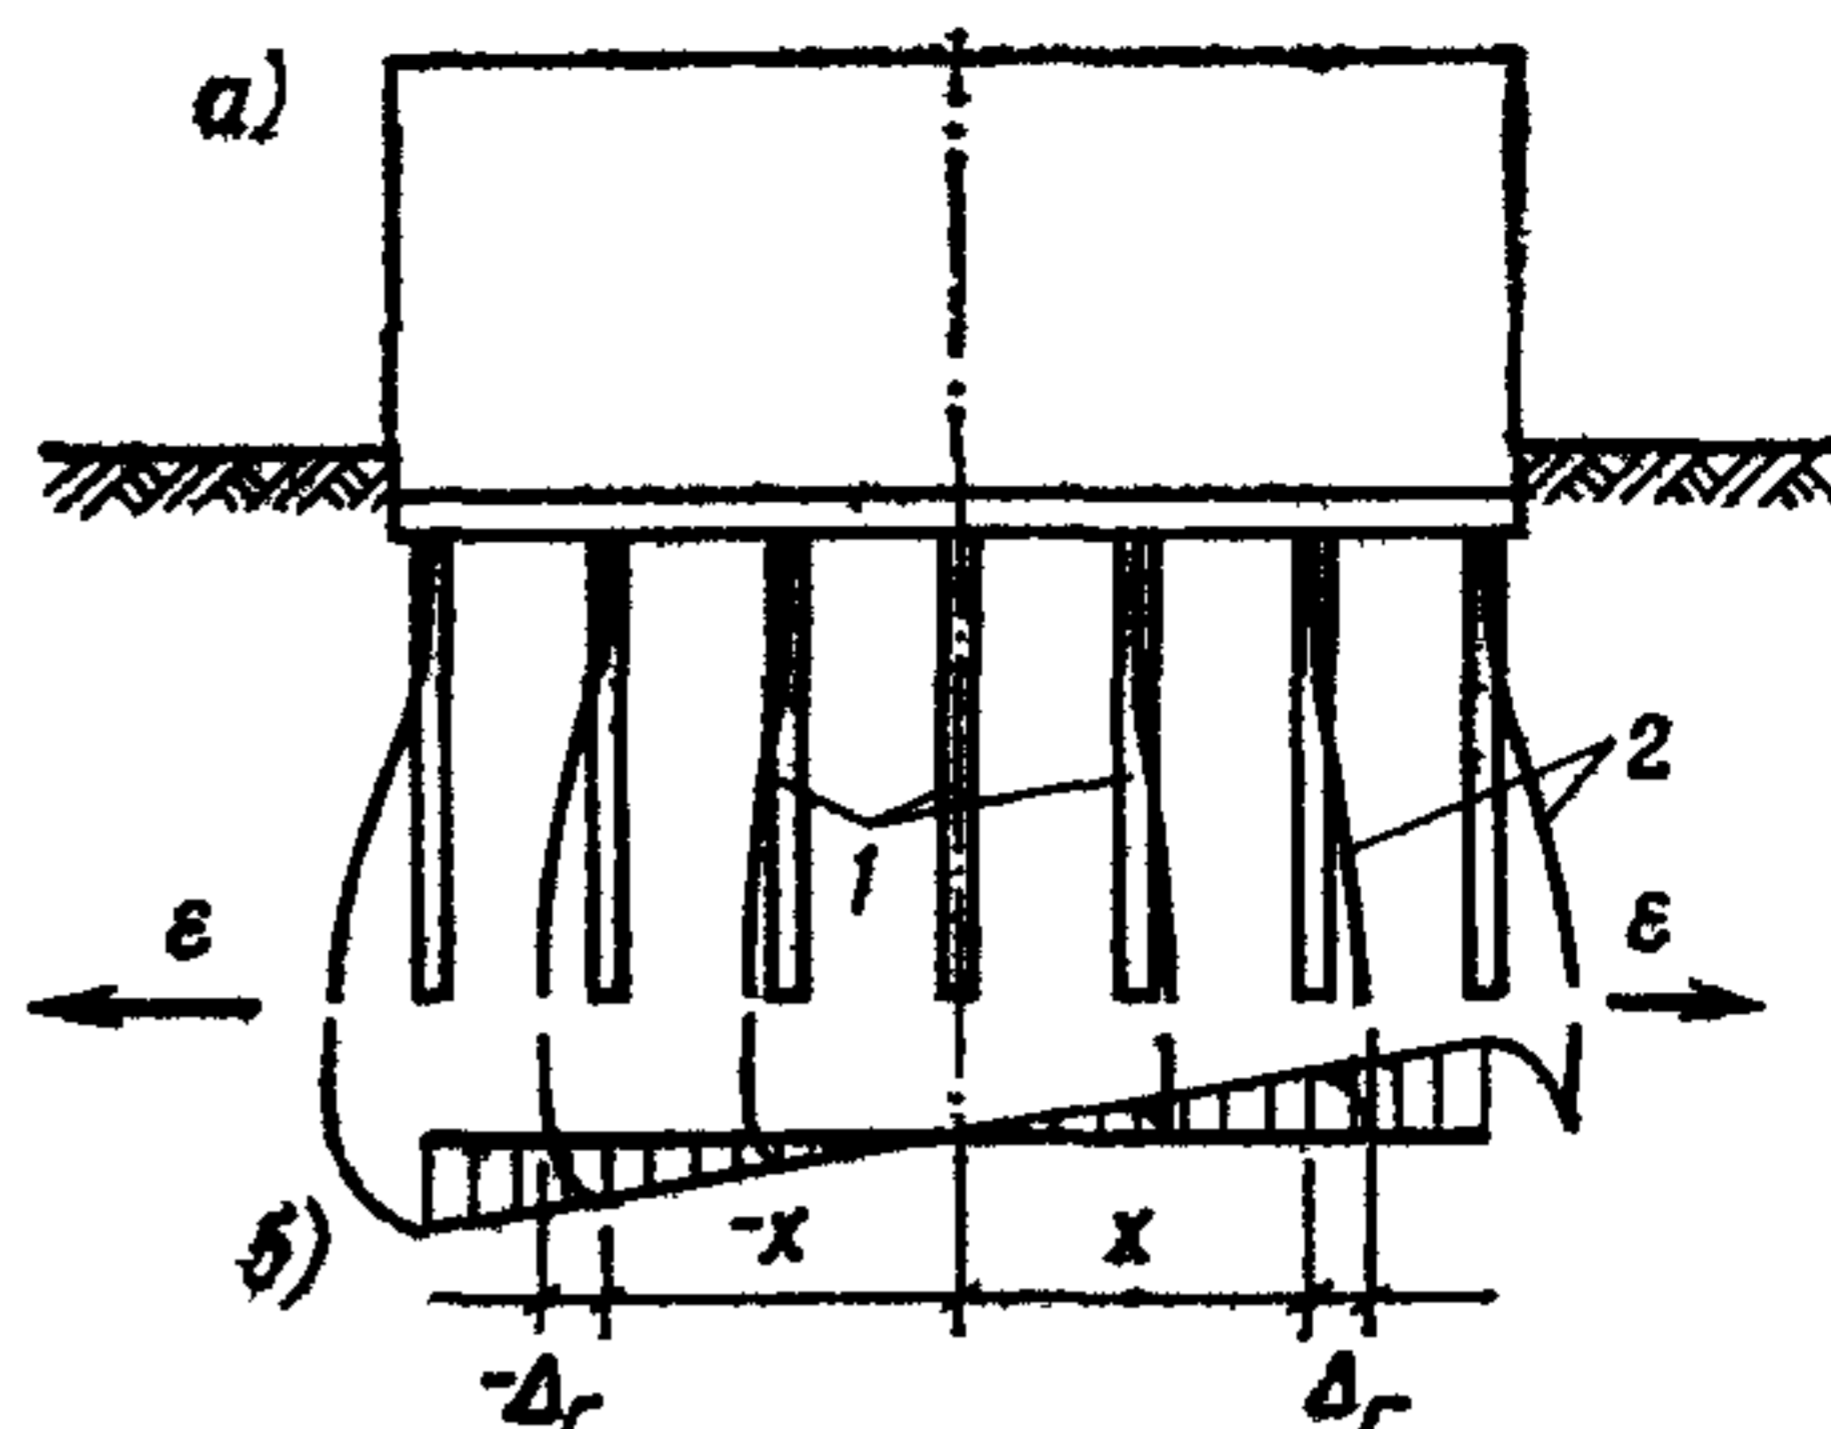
Воздействие горизонтальных перемещений грунта на свайный фундамент с жесткой заделкой голов свай в низкий ростверк
